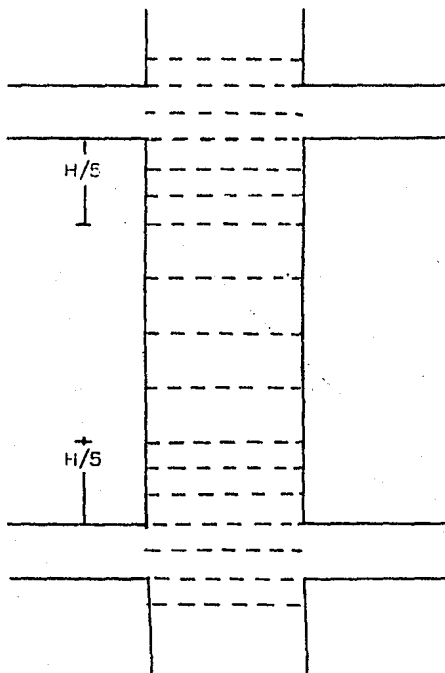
SECCION 5 DE LAS COLUMNAS C-27
